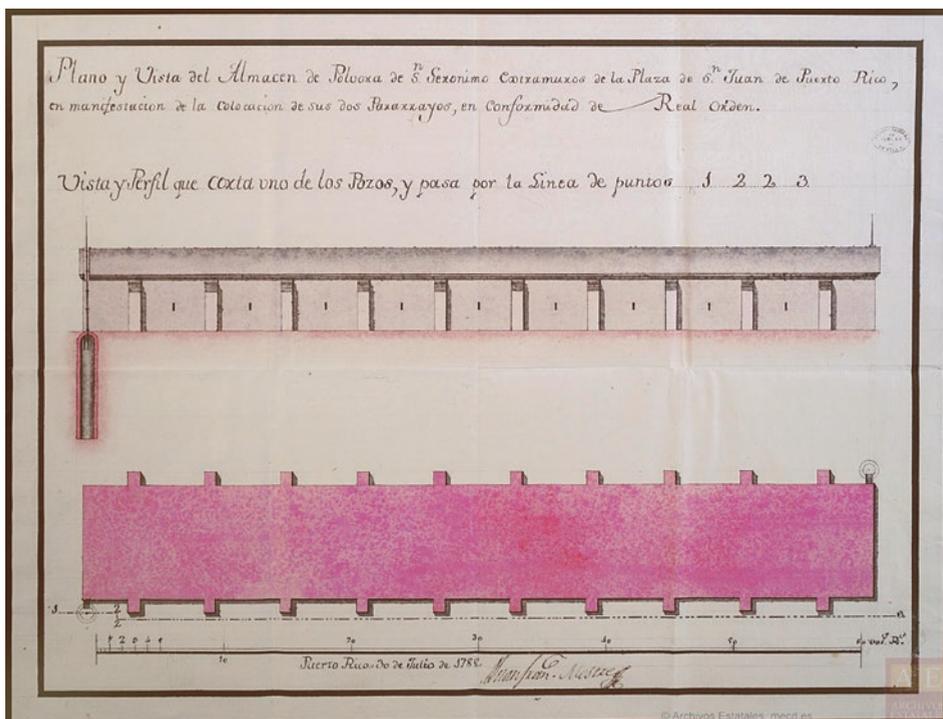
Plano perfil y elevación de un almacén nuevo de pólvora construido extramuros de la plaza.¹⁸
